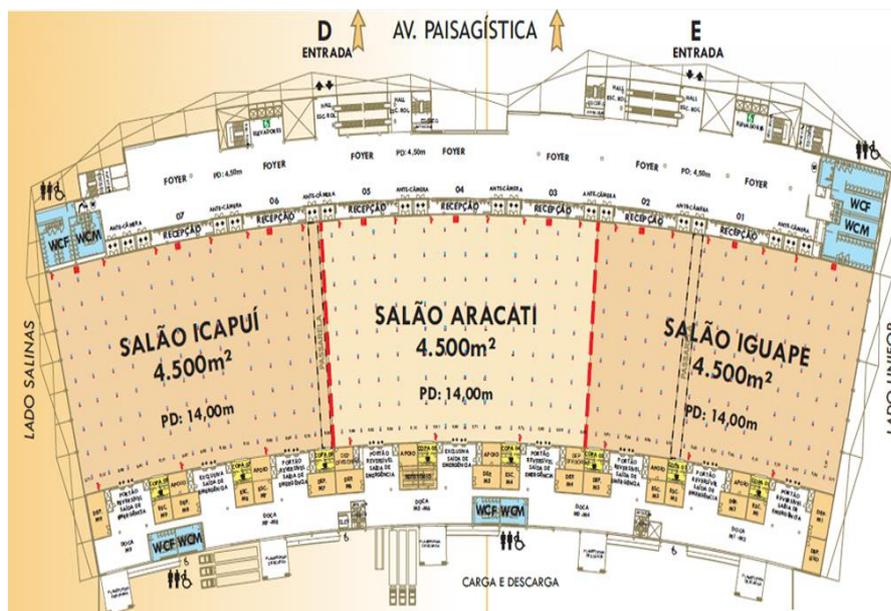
Planta baixa Pavilhão Oeste 2º mezanino.
